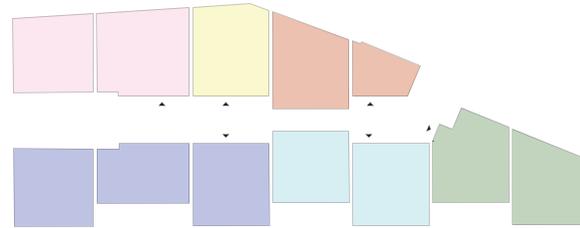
Wohnungsschema 2. Obergeschoss | M 1:500
